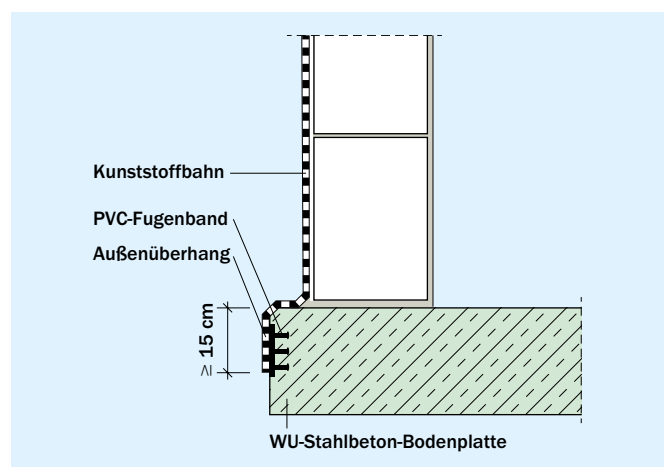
Übergang einer Abdichtung aus Kunststoffbahnen auf die Stirnfläche einer Betonbodenplatte mit Einbauteilen, z.B. mit in die Bodenplatte einbetonierten, außenliegenden und mit der Abdichtung kompatiblen Fugenbändern.
